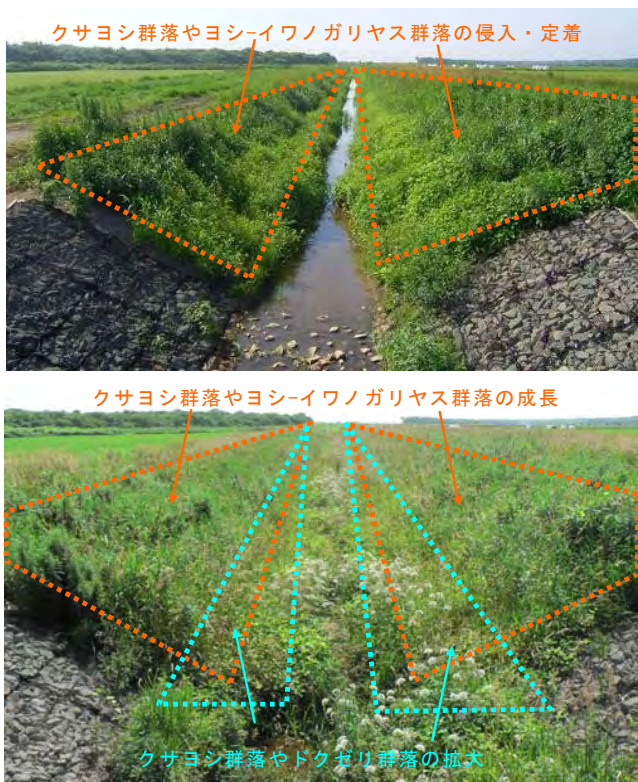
第1号排水路における法面被覆工施工箇所の植生状況（上：施工後1年目、下：施工後2年目）
